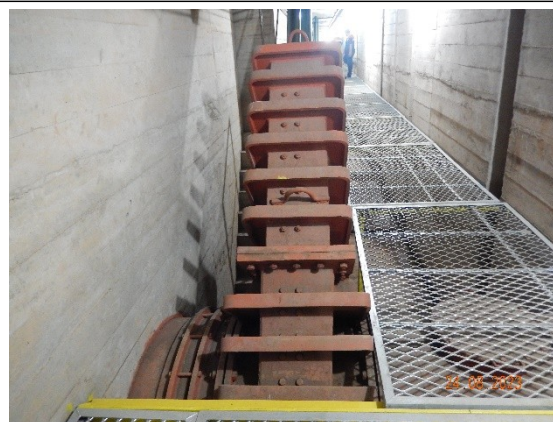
Galeria de inspeção com novo piso em grade metálica.
